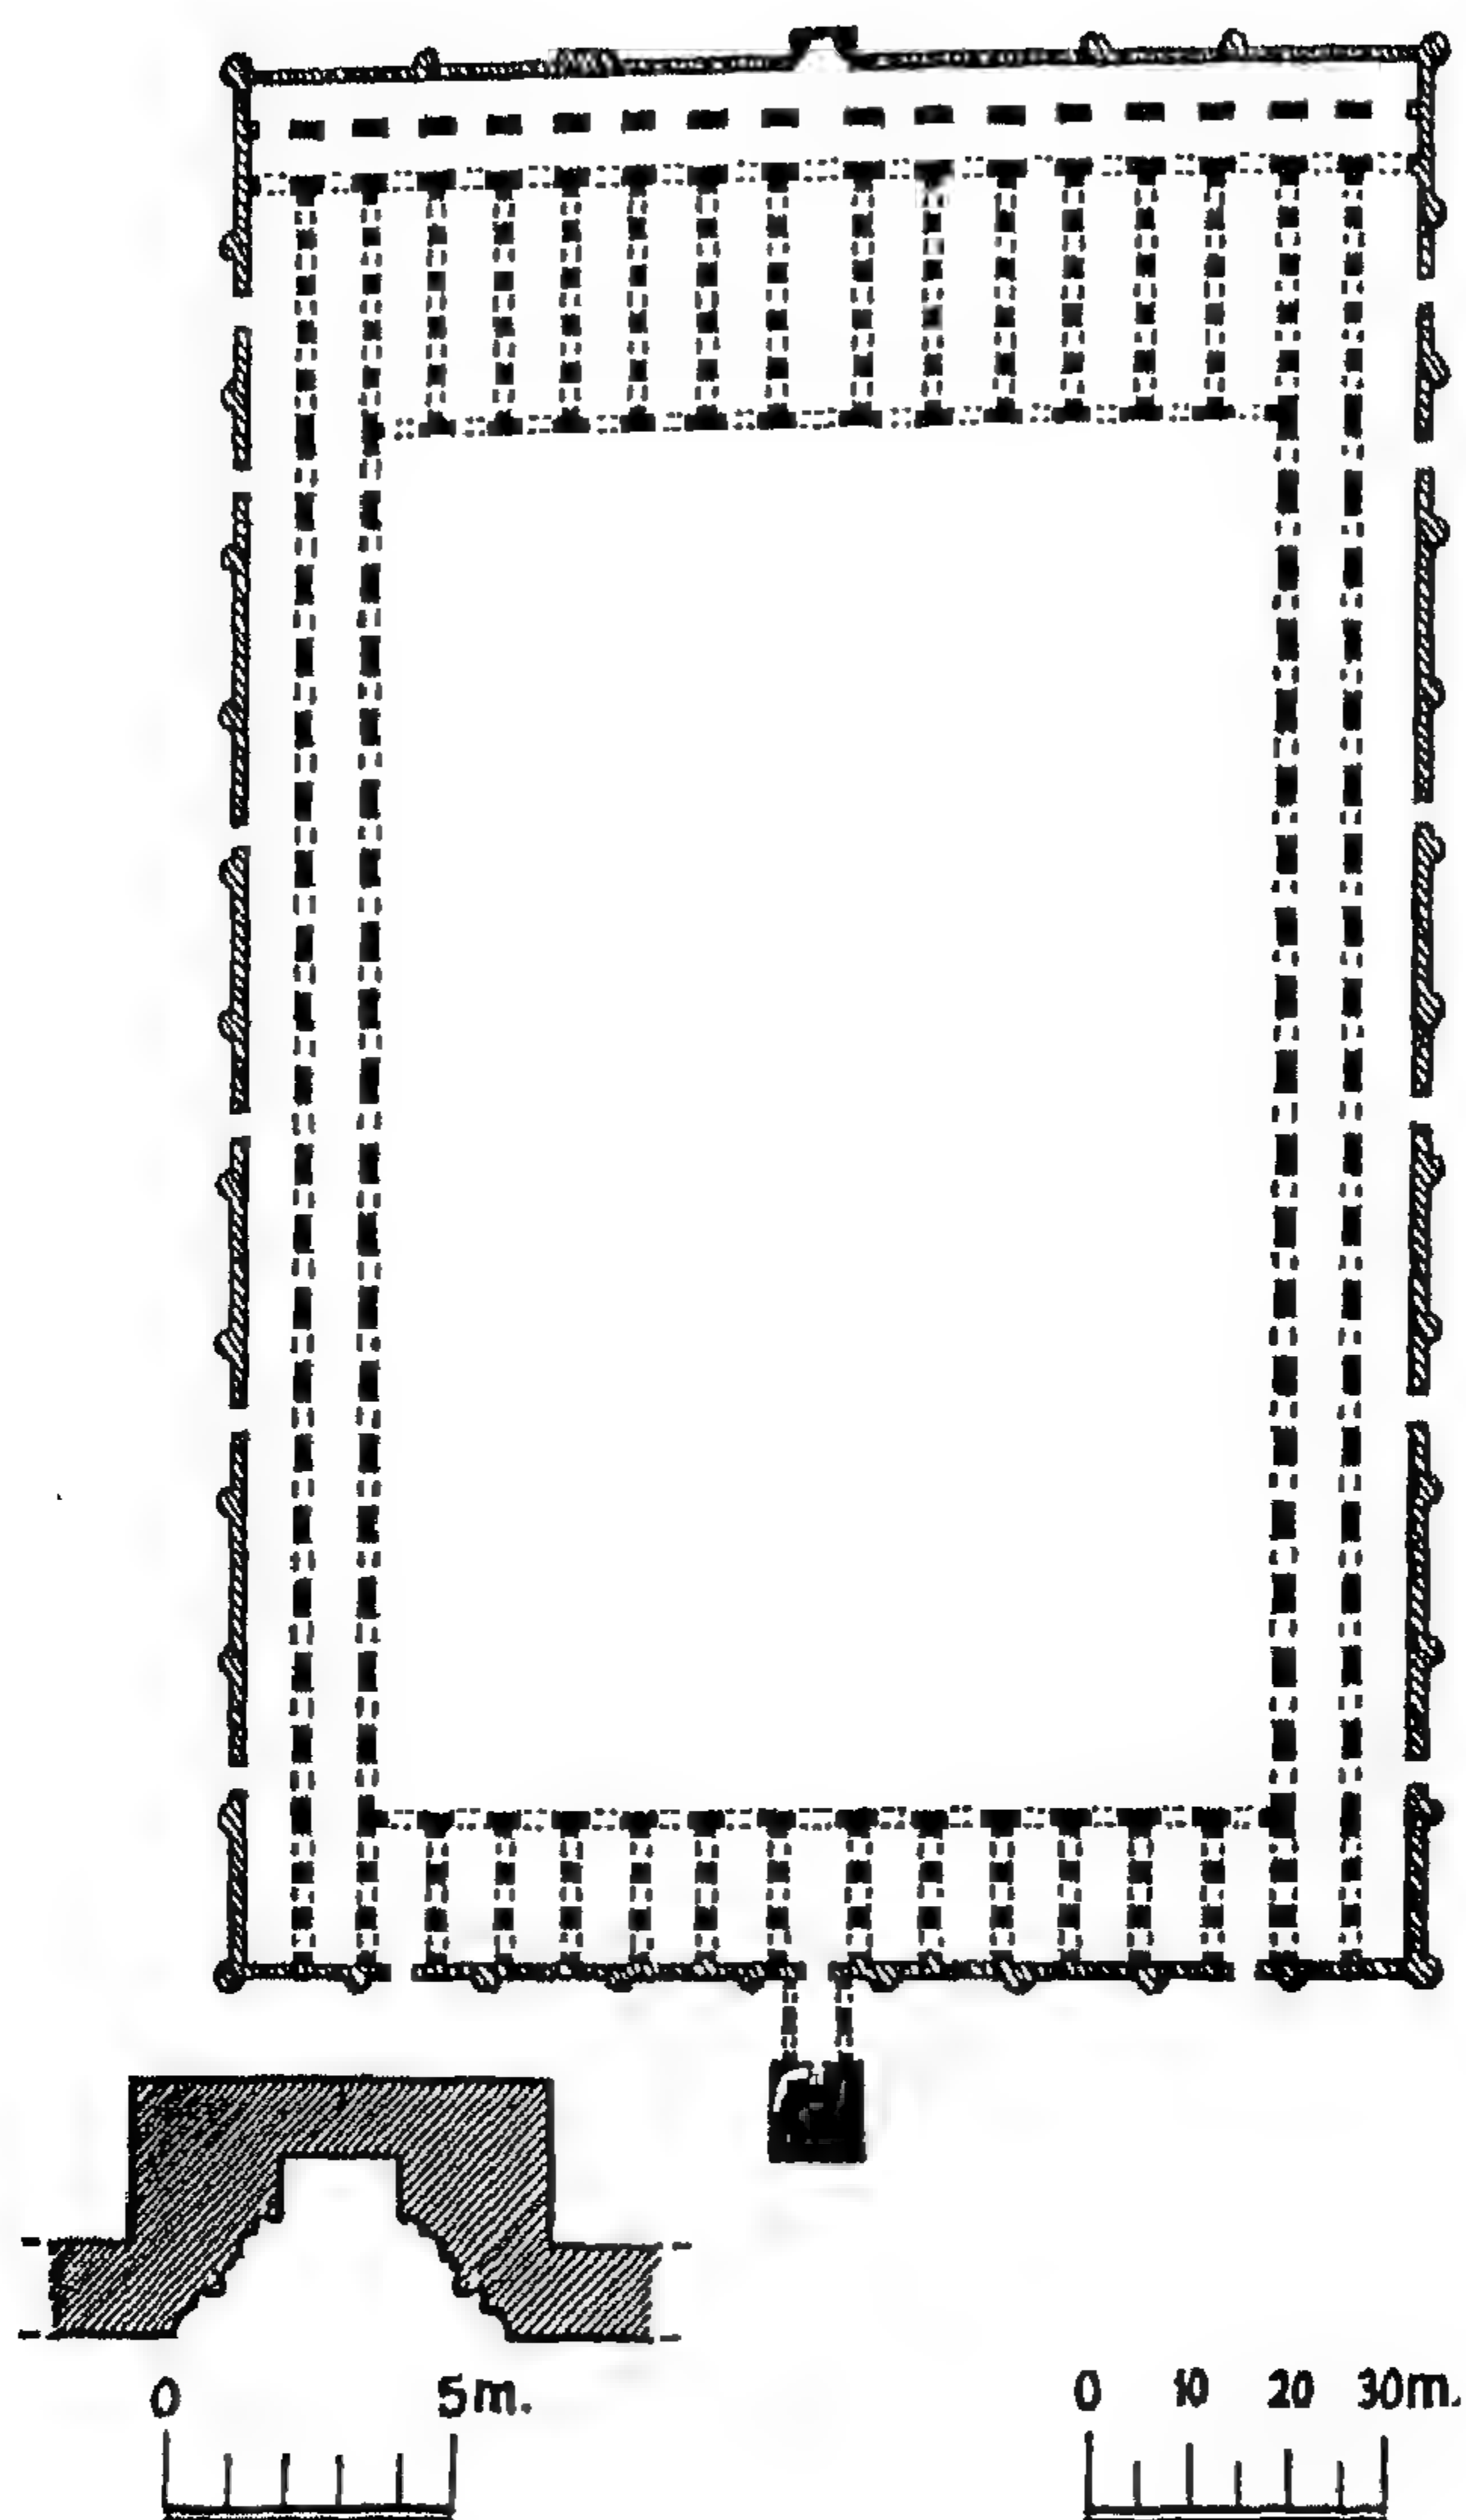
مسقط أفقي لجامع سامرا الكبير. (عن : كريزول) .
